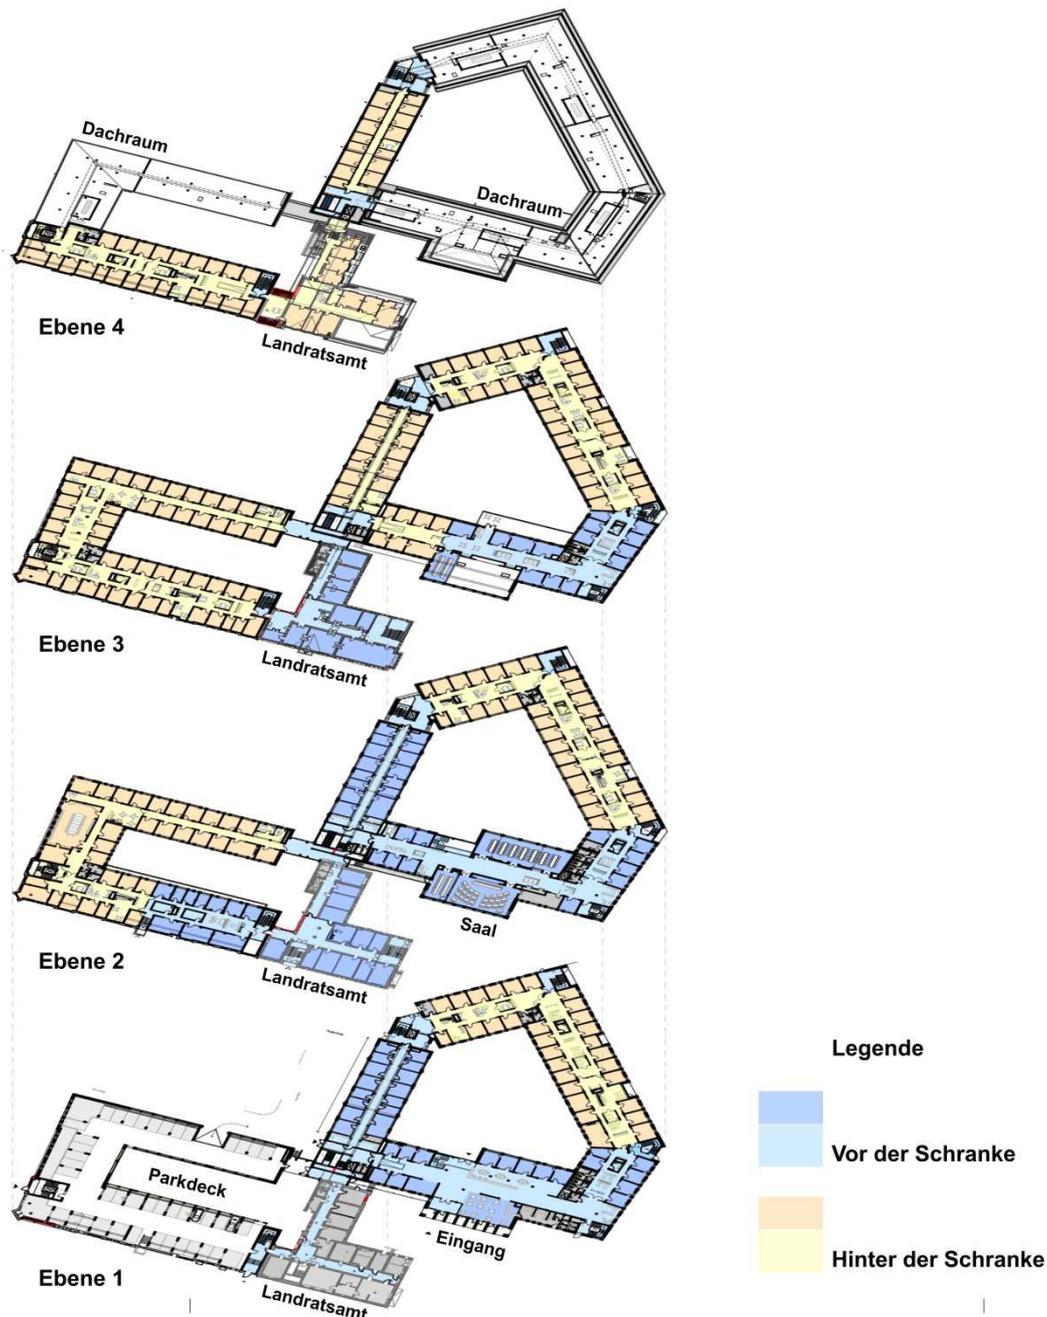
Prinzipgrundrisse mit öffentlichen und internen Bereichen
